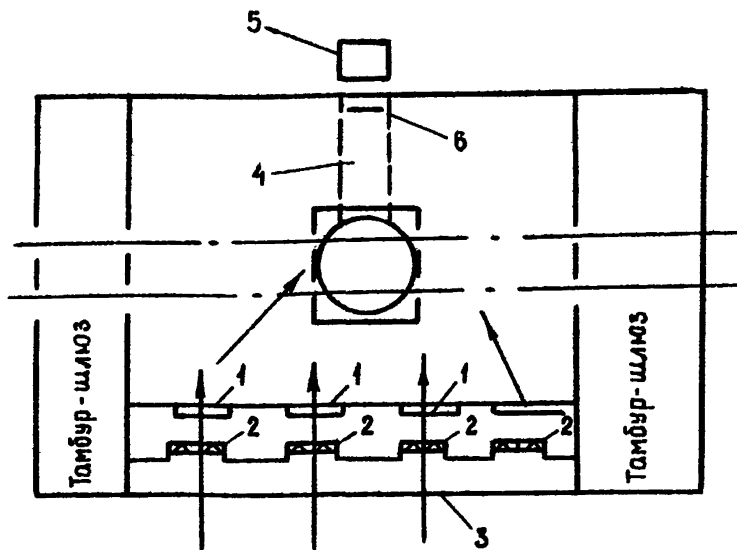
Схема расположения воздухонагревательной установки при стволах, оборудованных одноканатными подъемами: 1-многостворчатый клапан; 2-группы воздухонагревателей; 3-жалюзийная решетка; 4-воздухонагревательный канал; 5-воздухозаборная шахта; 6-льда
